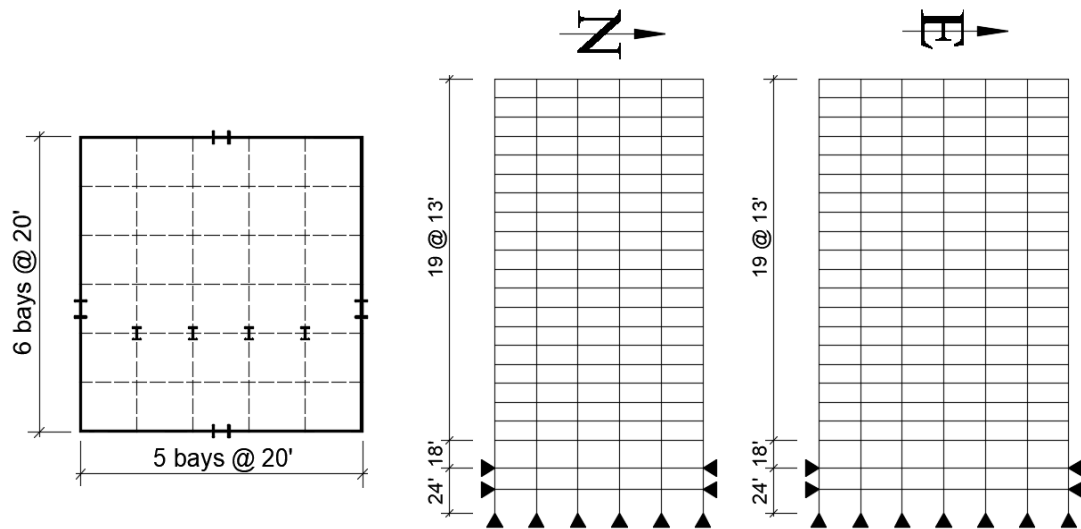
Planta y elevación del Modelo de 20 niveles.
